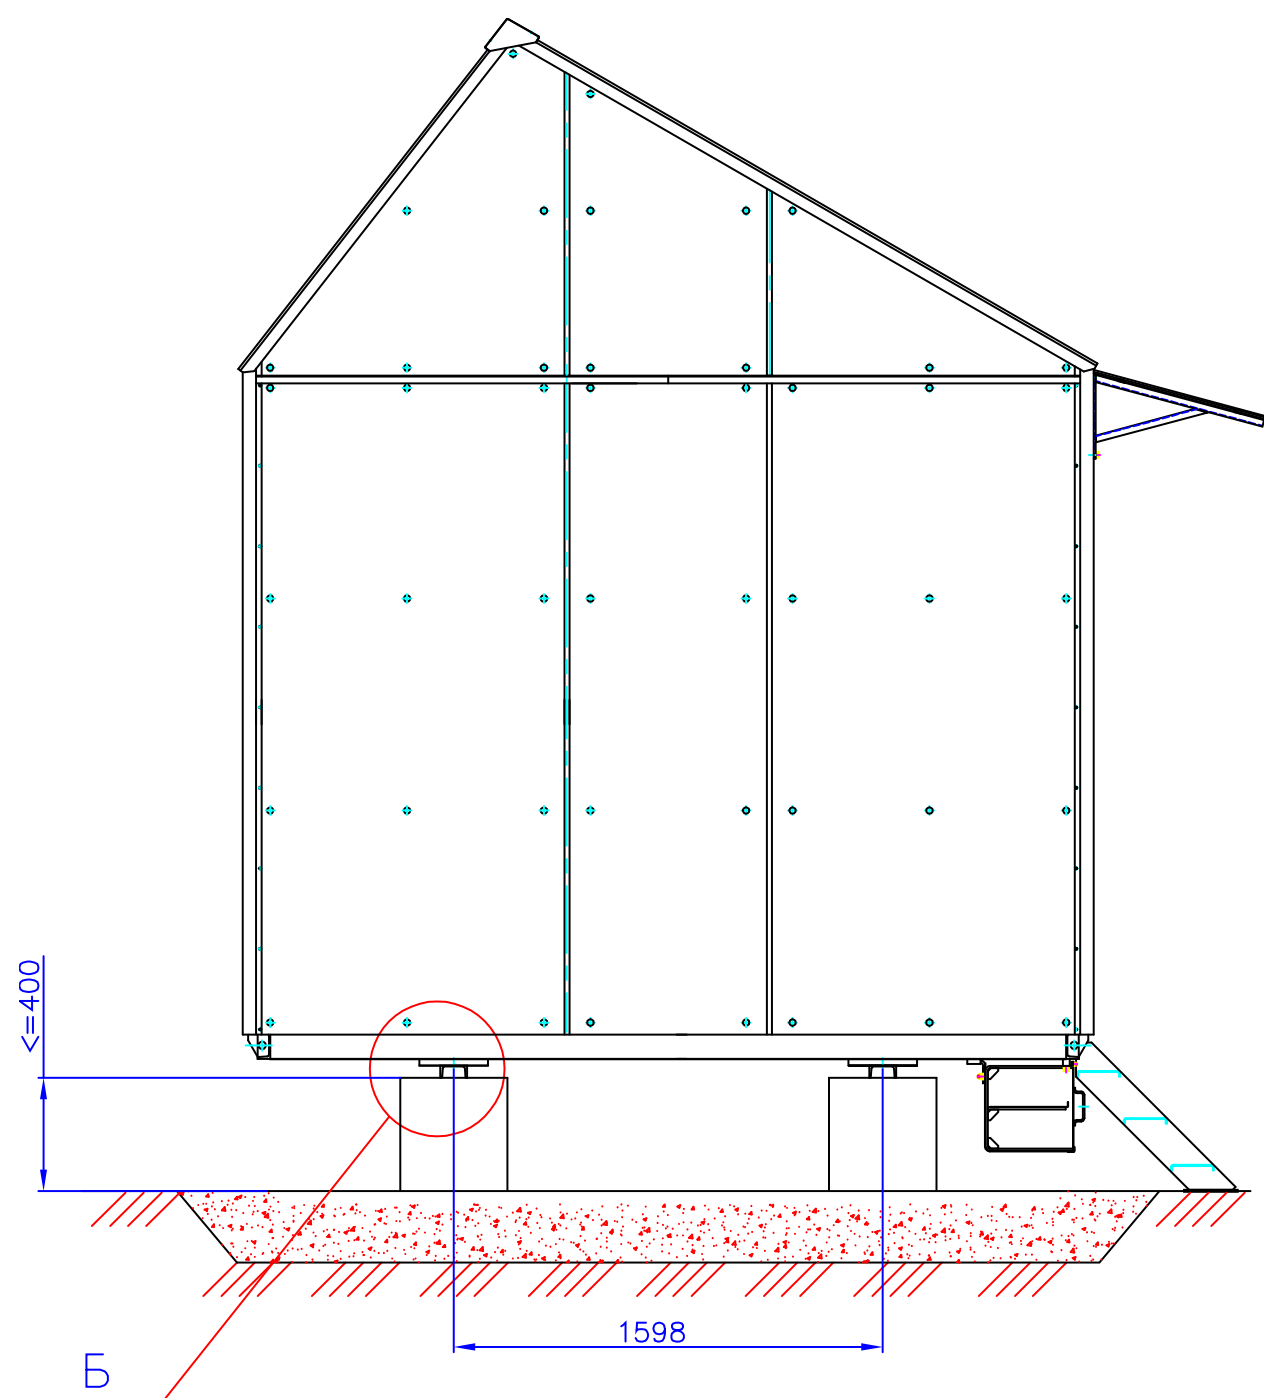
Установка модуля на бетонный ленточный фундамент
